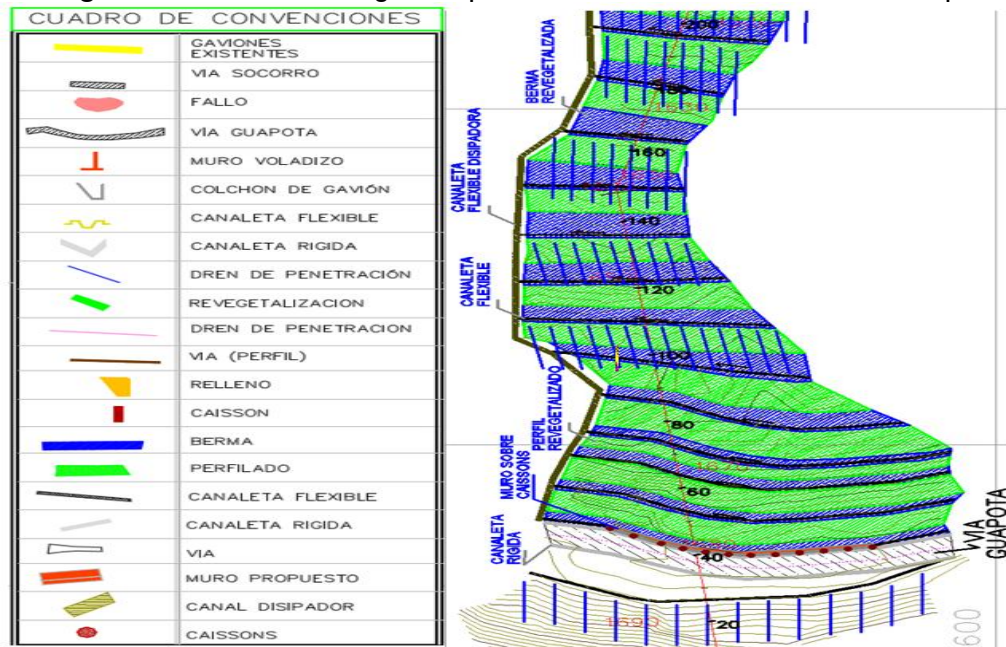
Obras de mitigación para la atención del deslizamiento – parte baja
